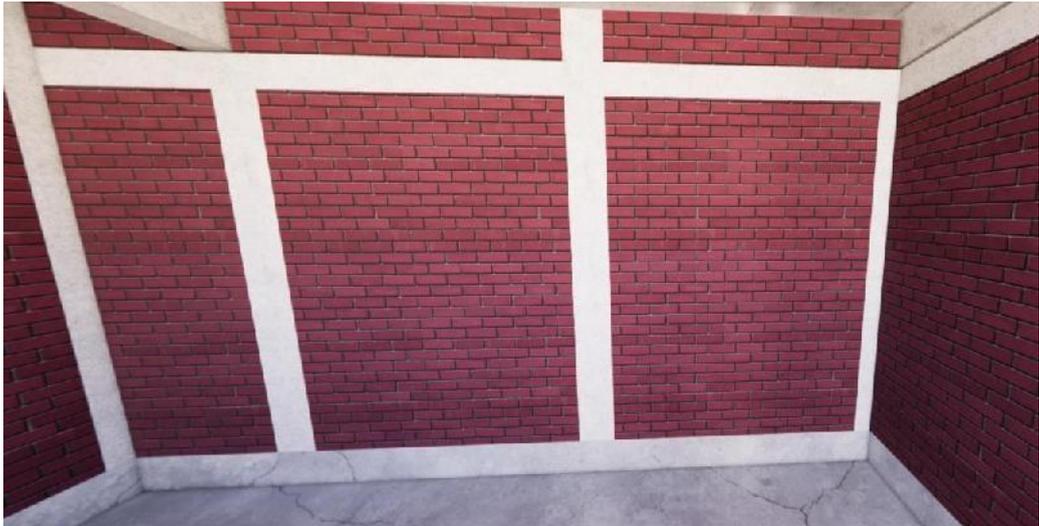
Vista 360° de estructuras generadas desde Escape
